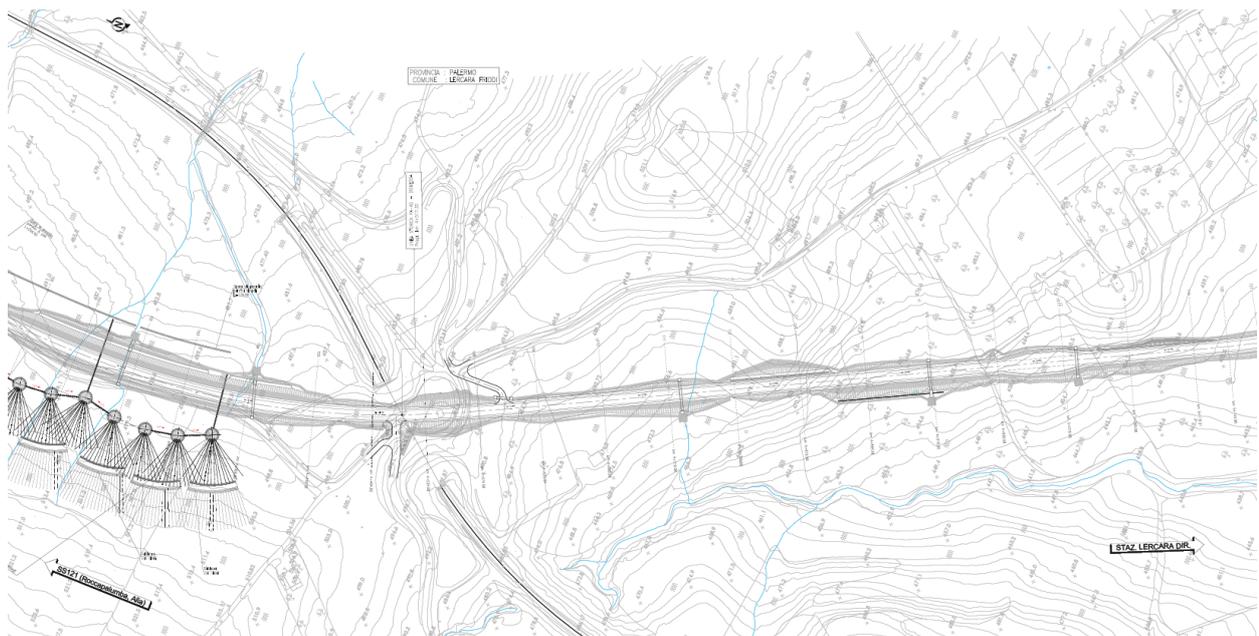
Planimetria di progetto dalla Km 4+300 alla Km 5+145
